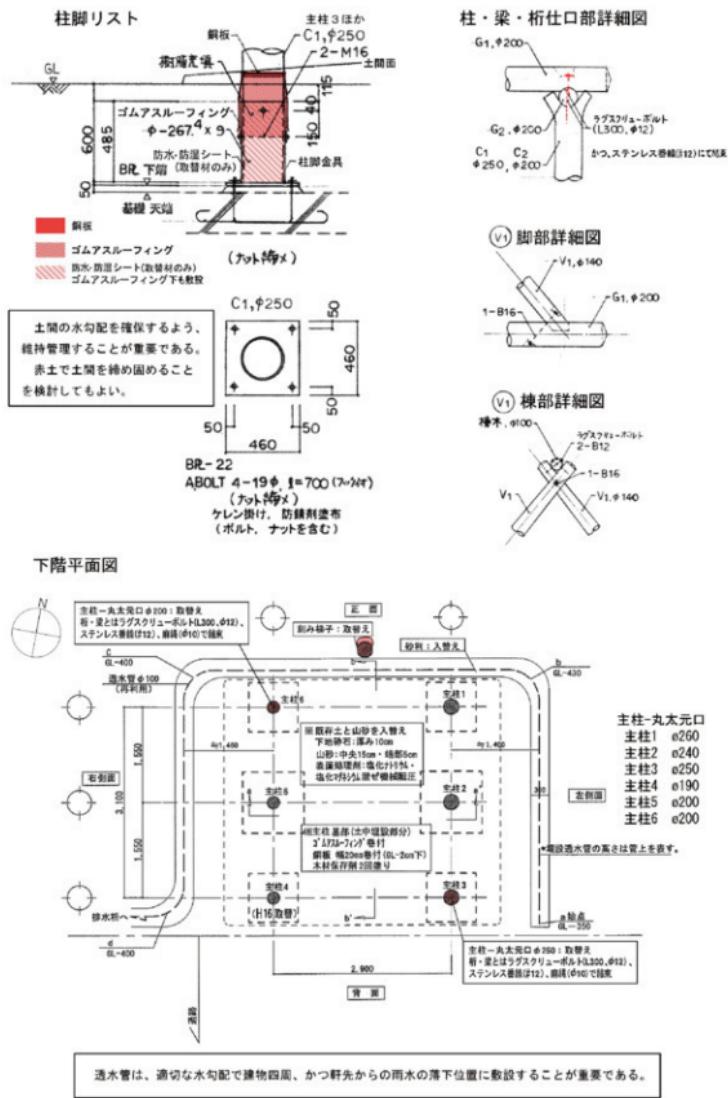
復原建物4竣工図(3) 柱脚リスト: 1/30、詳細図: 1/40、下階平面図: 1/80
